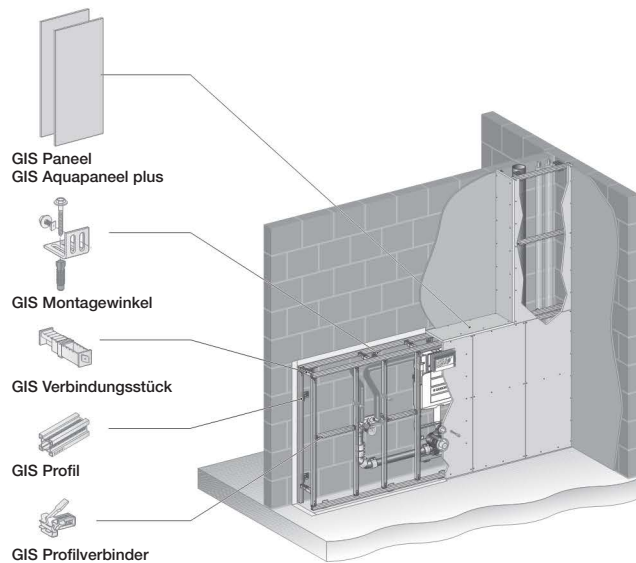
Geberit GIS Installationssystem Vorwandinstallation
